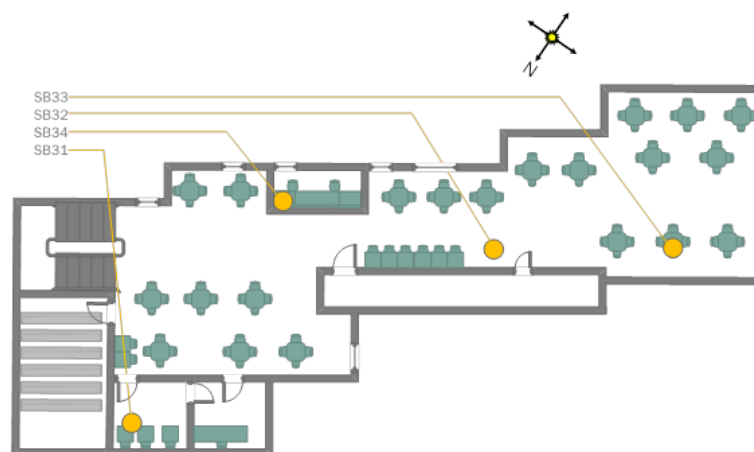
Ubicación de los sensores en la segunda planta alta
